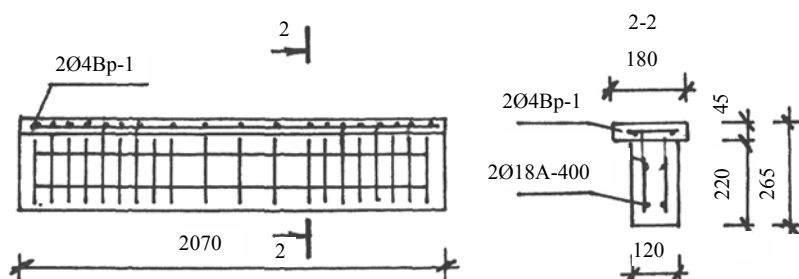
Схема армирования балок после усиления наращиванием в сжатой зоне
